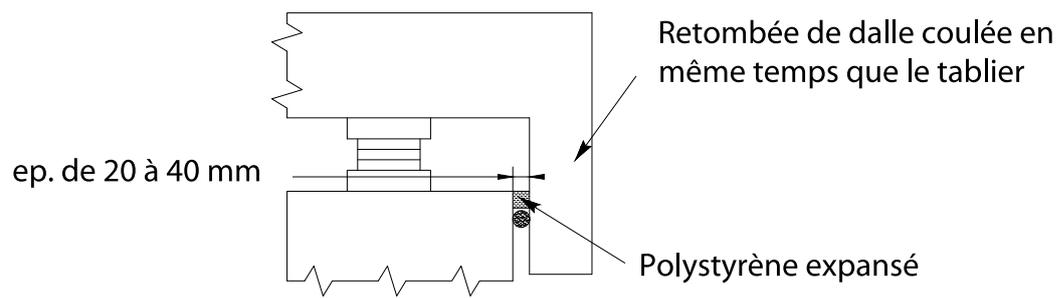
Aménagement dans le cas d'un ouvrage avec retombée de dalle
